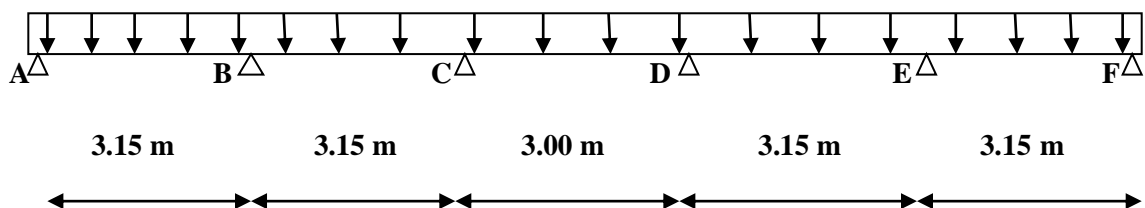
Schéma statique de la poutre continue reposant sur 6 appuis.
